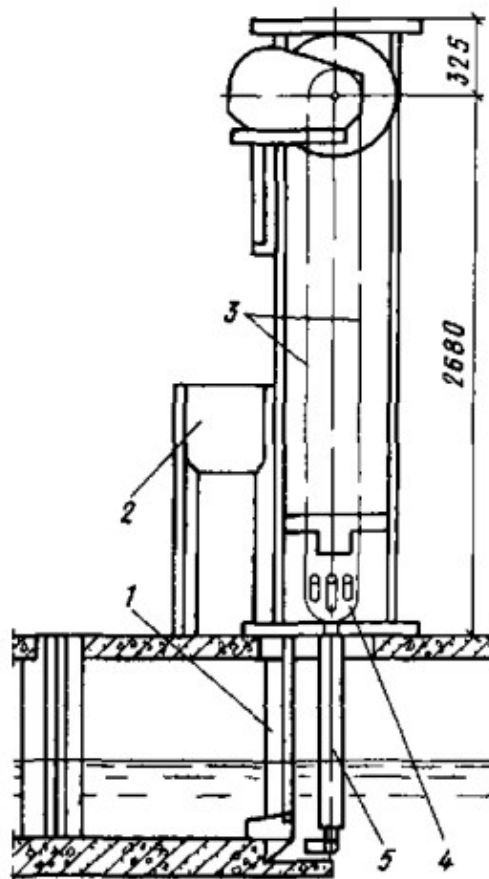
Схема установки вертикальної решітки (механізовані).
